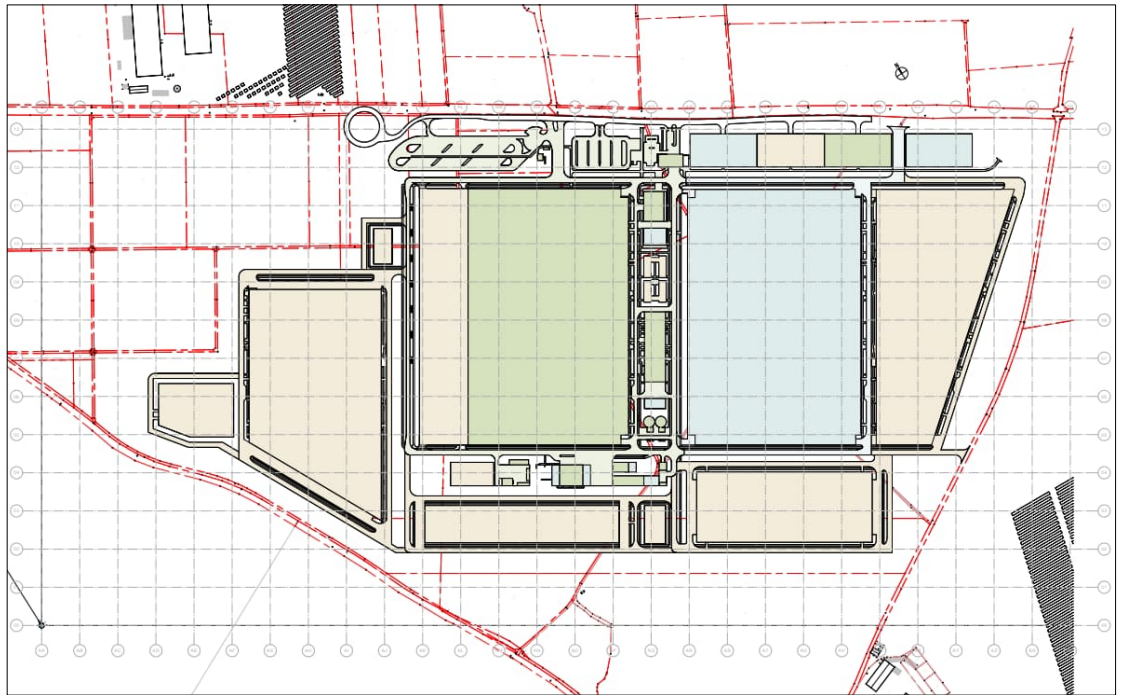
Planfall 3 mit Gebäuden (BA1 hellgrün, BA2 hellblau, BA3 gelb)
